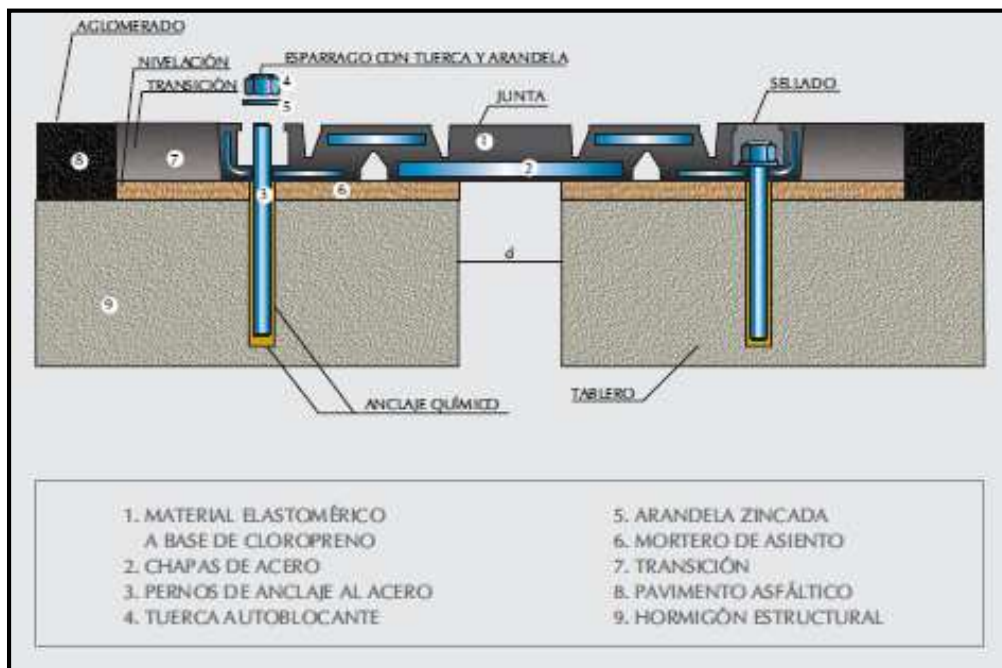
Junta de perfil elastómero armado. Imagen en Ref. [2]
